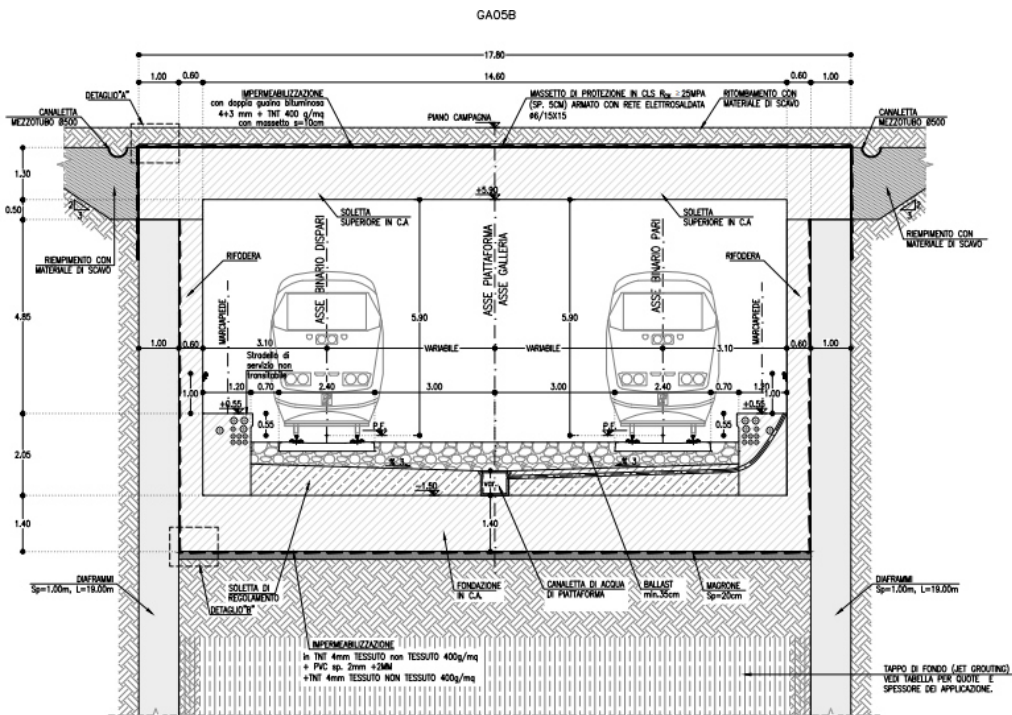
Sezione Galleria GA05 tratto su diaframmi
